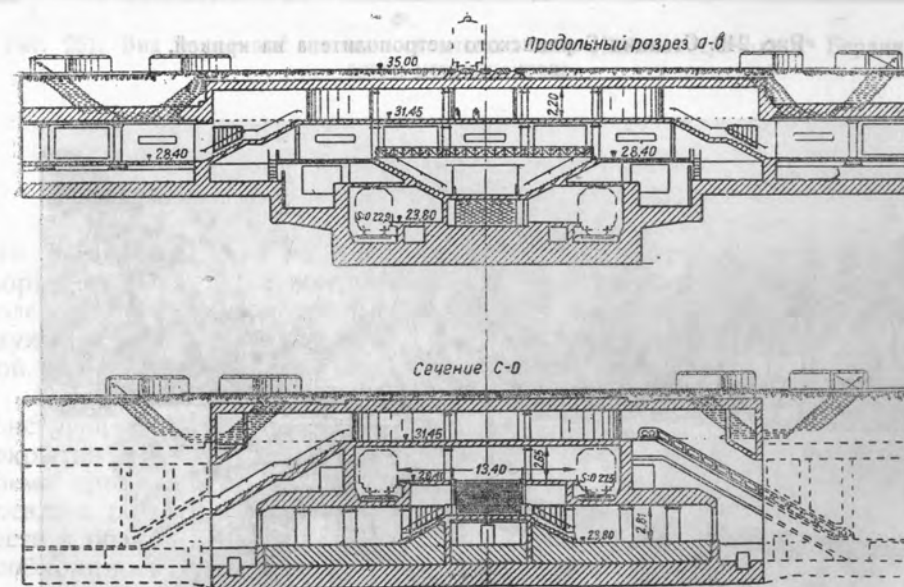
248. Разрезы по конструкции пересечения подземных станций метрополитена.
